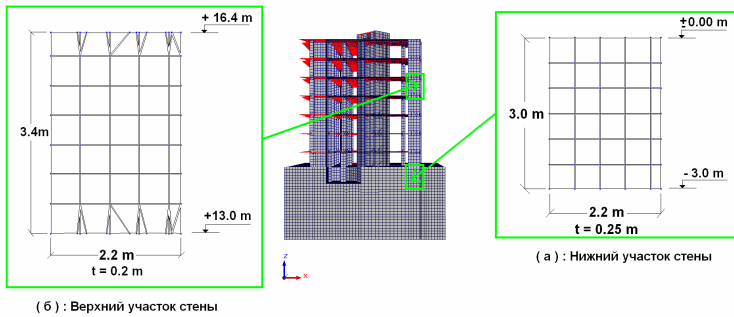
Расположение и размеры участков монолитных железобетонных стен здания – вариант (В)
